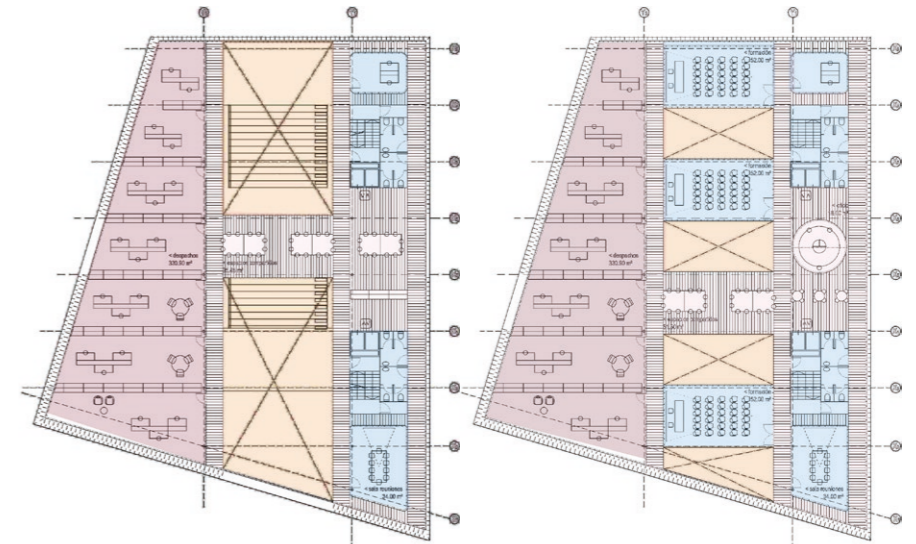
Planta cuarto piso. Adaptado de Plataforma de Arquitectura, 2016
